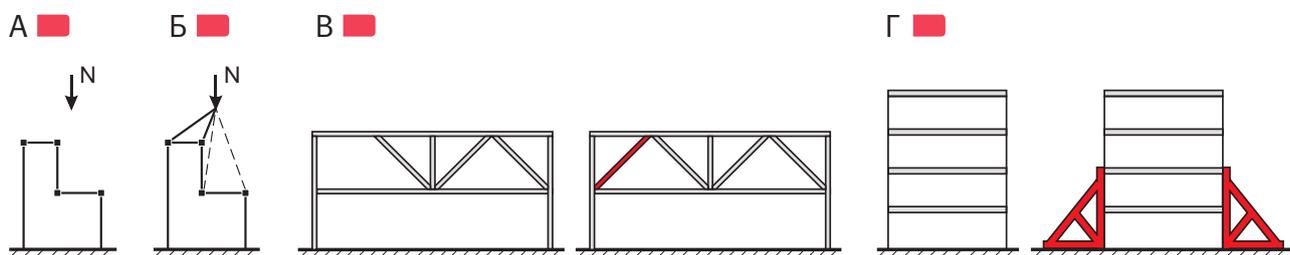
А, Б – надстройка с передачей усилий кратчайшим путем: А – точка получения усилия и возможные точки восприятия, Б – план подвала после замены стена колонны; В – принцип неразрывности передачи усилий при восстановлении отсутствующего раскоса фермы; Г – концентрация материала пропорционально моменту в решетчатых контрфорсах
